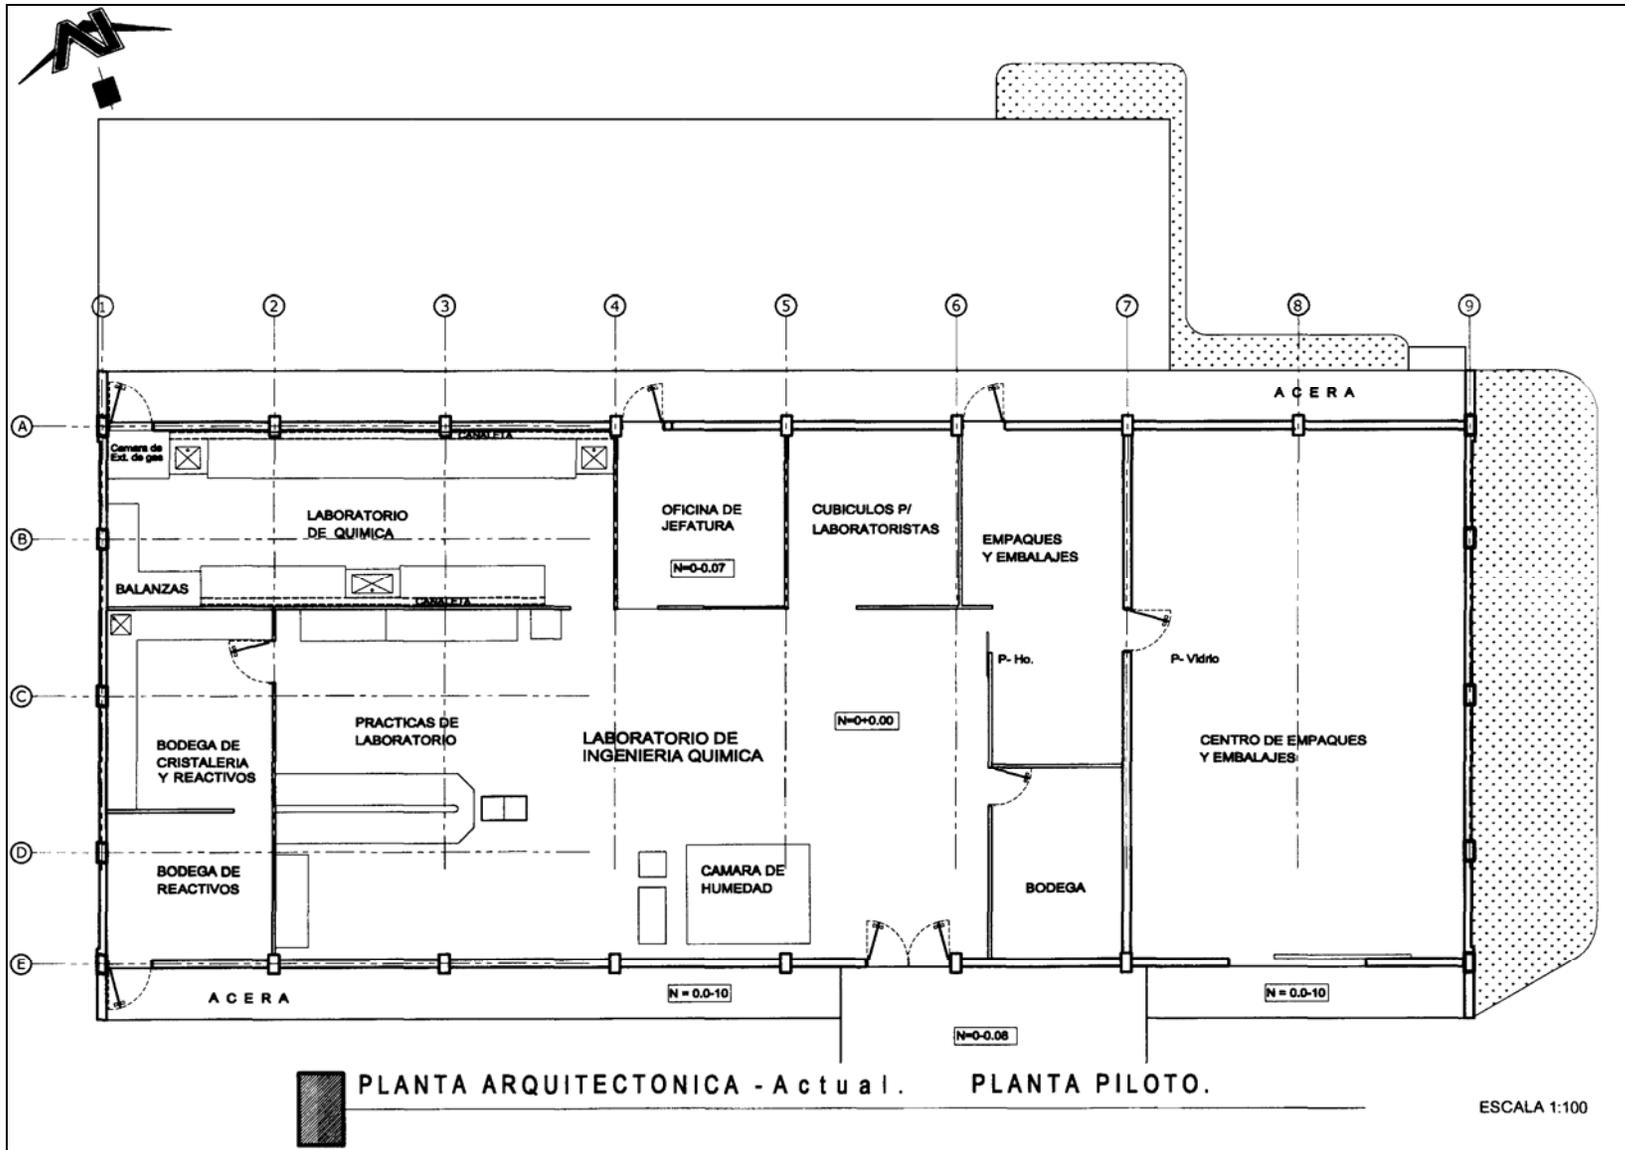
Plano arquitectónico de los laboratorios de Ingeniería Química (planta piloto).
